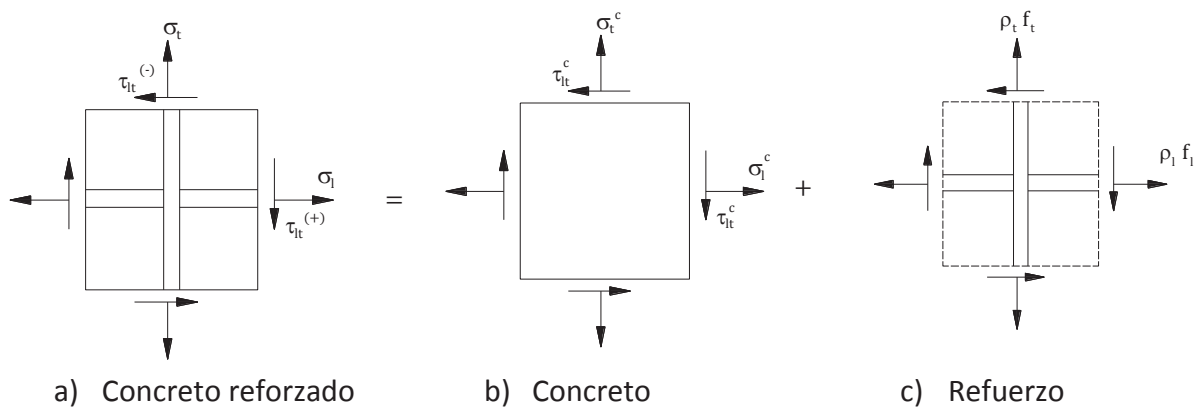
Elemento membrana de concreto reforzado sujeto a esfuerzos en el plano
